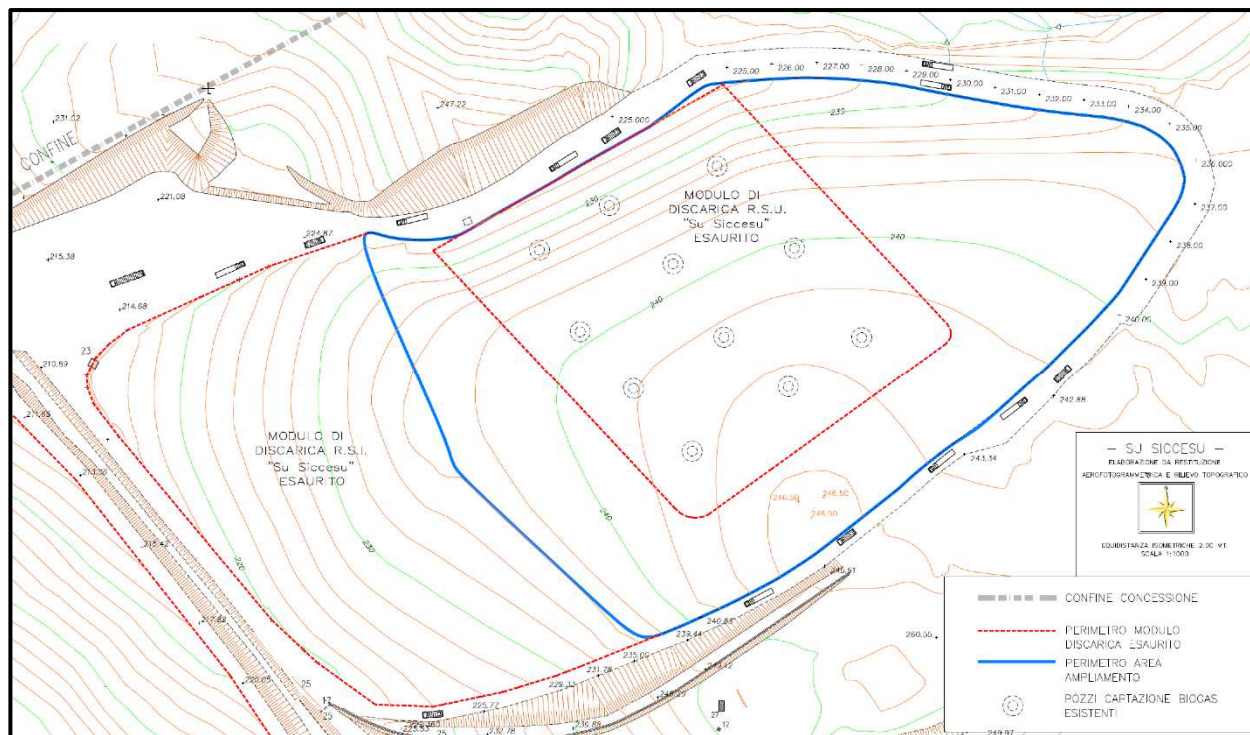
/II: Planimetria modulo n. 6 (perimetro in blu)
